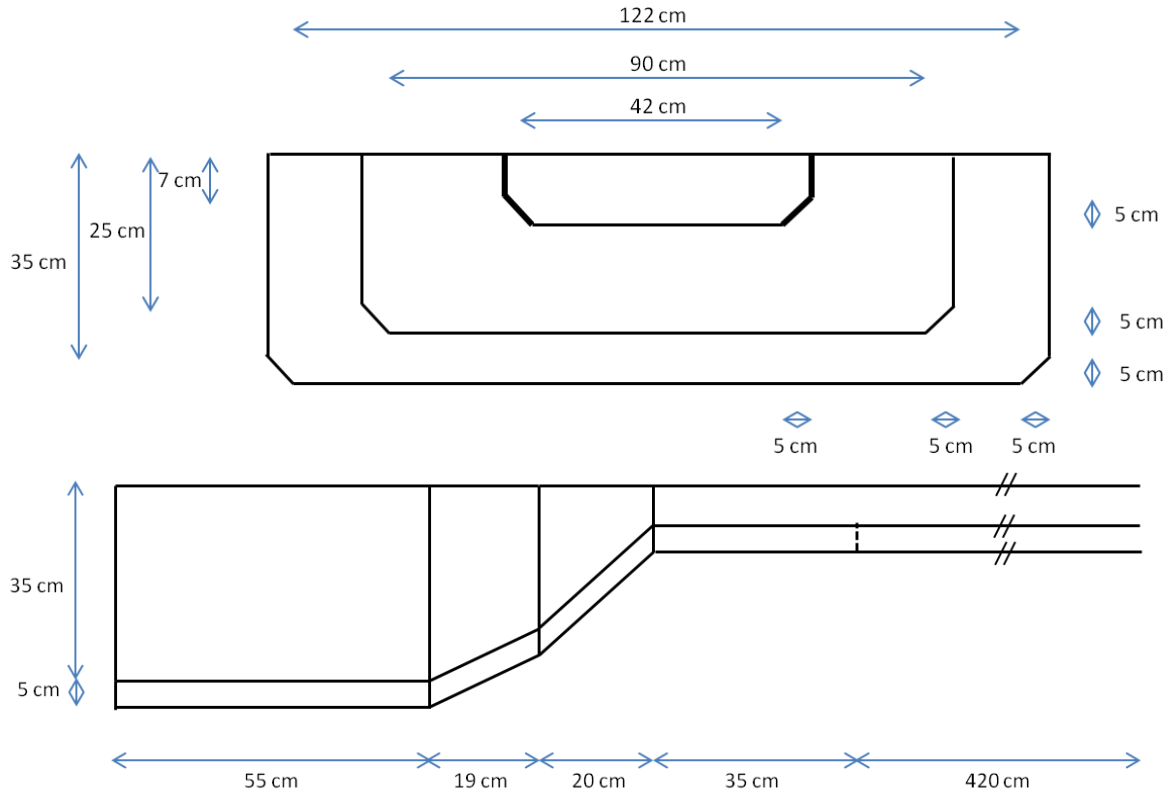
Dimensions de face et de côté du conduit plafonnier ouvert.
